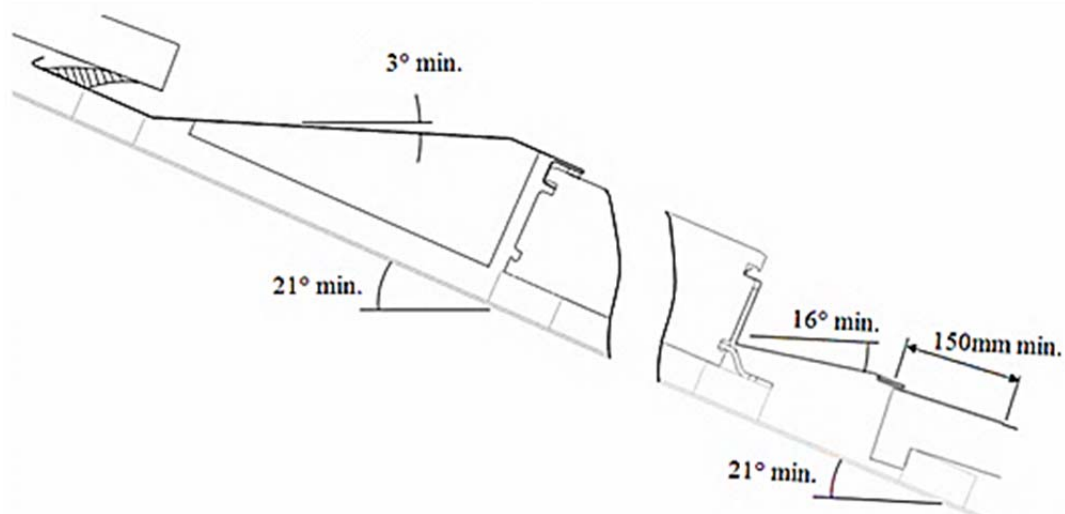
Vue en coupe – Pentes minimum et recouvrements.
